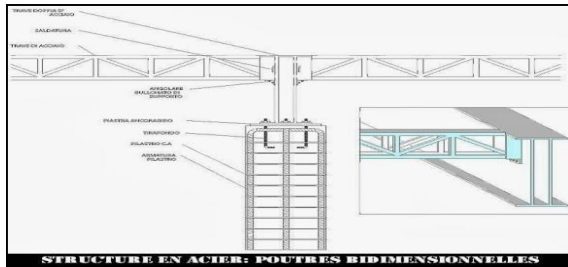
Assemblage poteau métallique poutre bidimensionnelle
